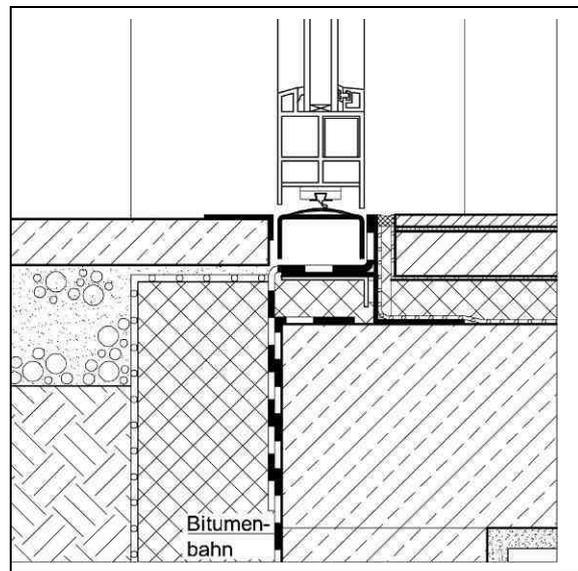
Detailskizze Abdichtung Türschwelle
